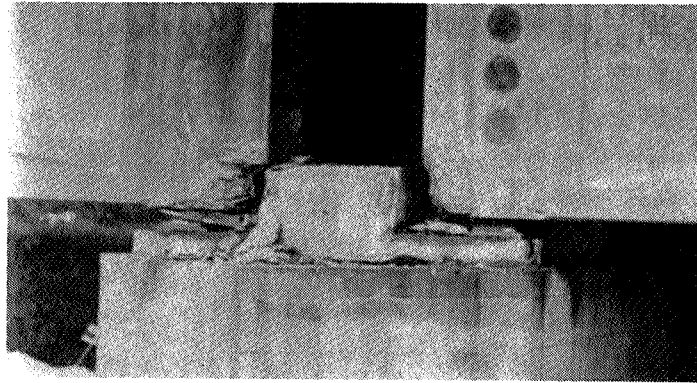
Destruction d'un appareil d'appui. Frioul (1976).
